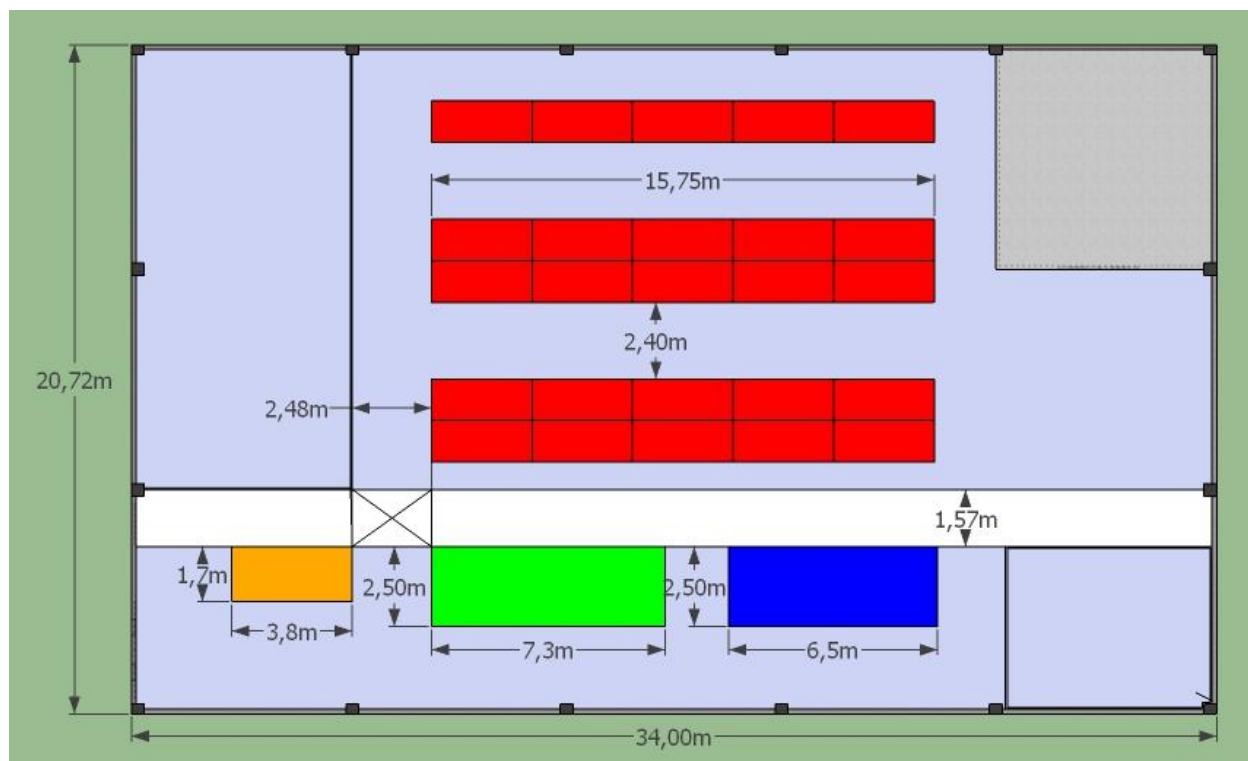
Layout Propuesto del almacén (plano planta Sketchup)
